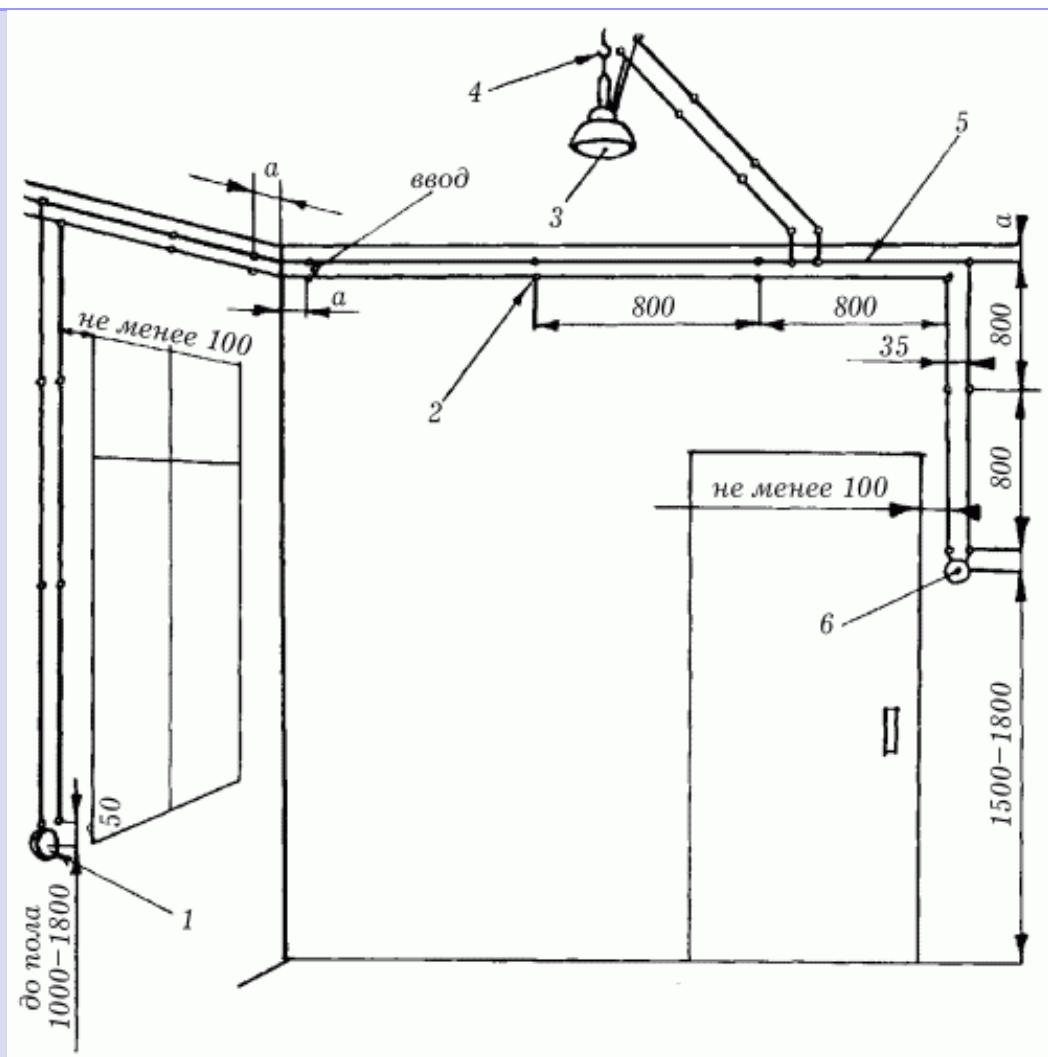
Прокладка проводов марок АППВ, АПР, АПРВ, АПН внутри помещения на роликах: а – 1,5–2 высоты ролика; 1 – розетка штепсельная; 2 – ролик; 3 – светильник; 4 – крюк для крепления светильника; 5 – провод электропроводки; 6 – выключатель.
